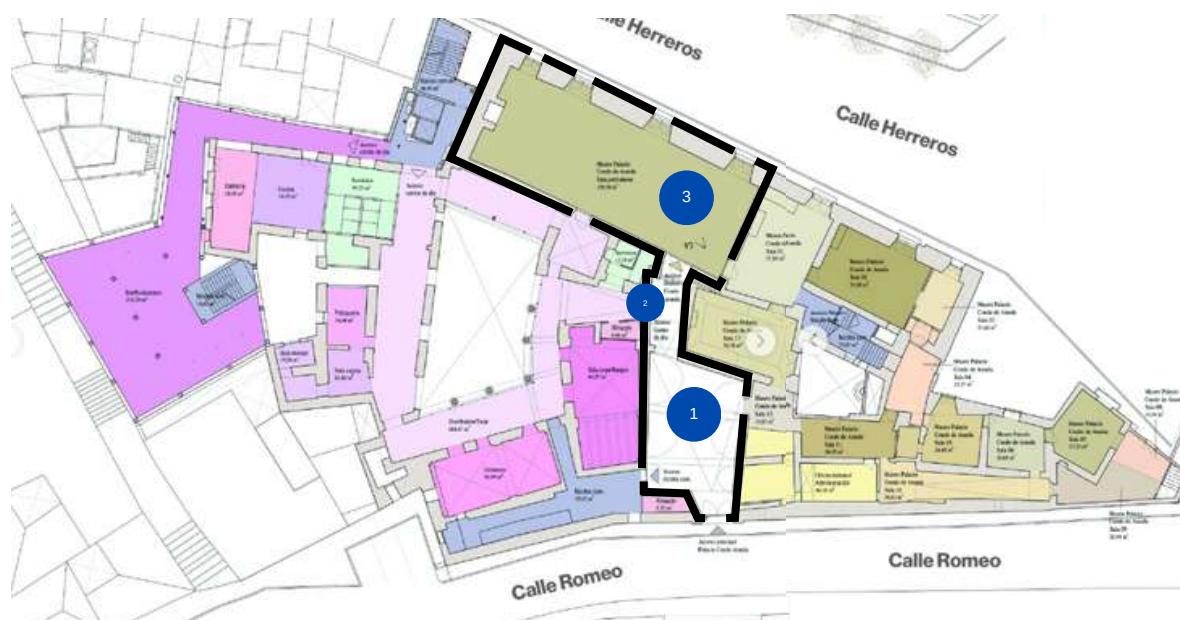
Plano de la 3^a planta del Palacio del Conde de Aranda con las salas de la exposición
